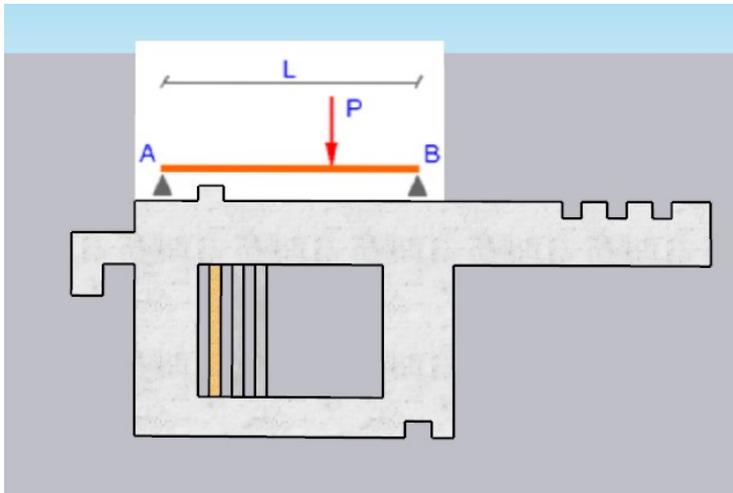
Esfuerzos del módulo para el cálculo de la longitud de anclaje.
